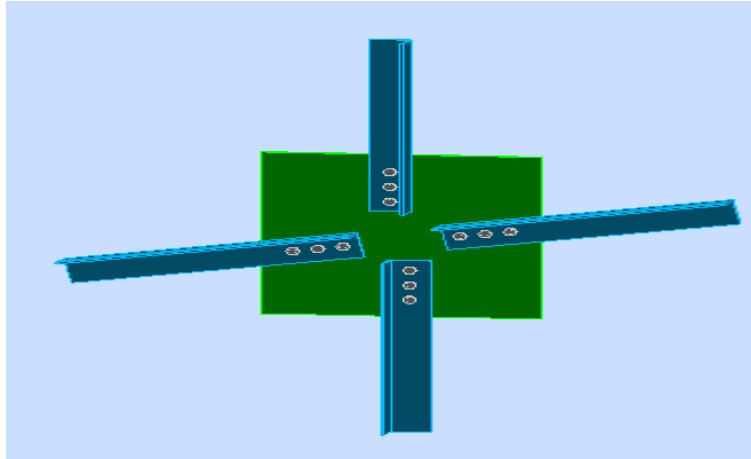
Vue de l'assemblage de la poutre au vent
